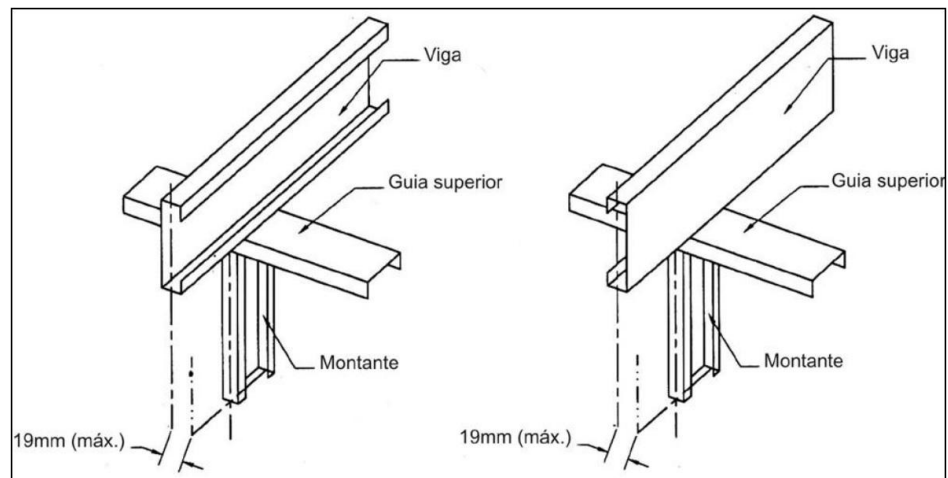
Vigas apoiadas sobre paredes centrais. Fonte: Centro Brasileiro em Construção em Aço.
